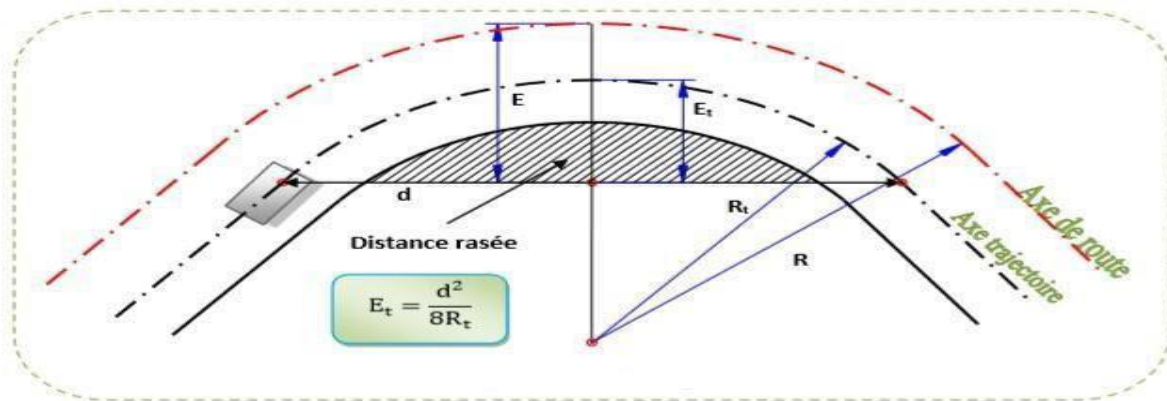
Les éléments géométriques d'un tracé en plan.
